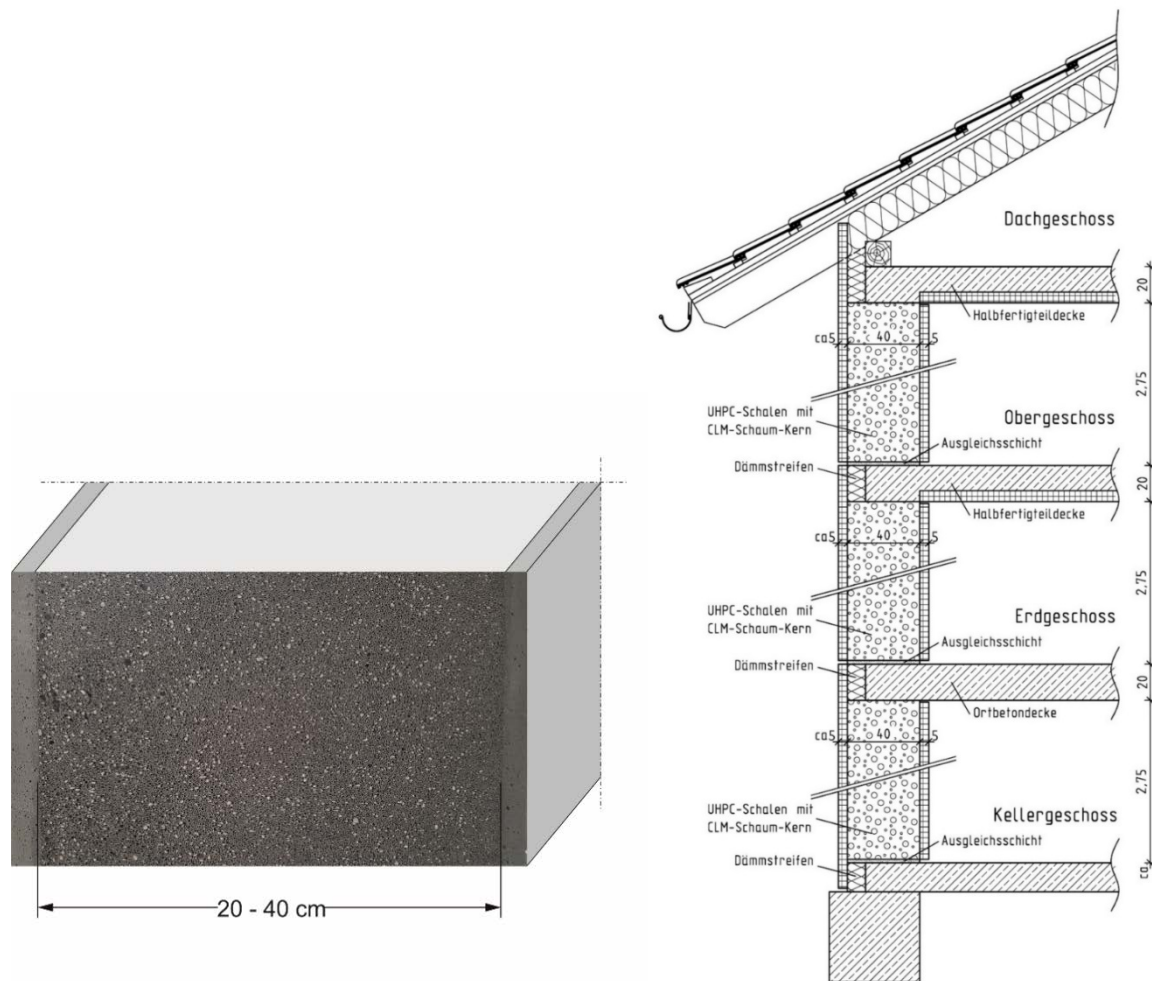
Ausschnitt eines Wandelements (links) und mögliche Bauausführung (rechts).
